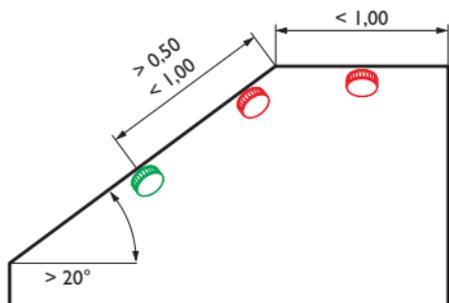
Gerade Montagefläche weniger als 1 m lang und 1 m breit
